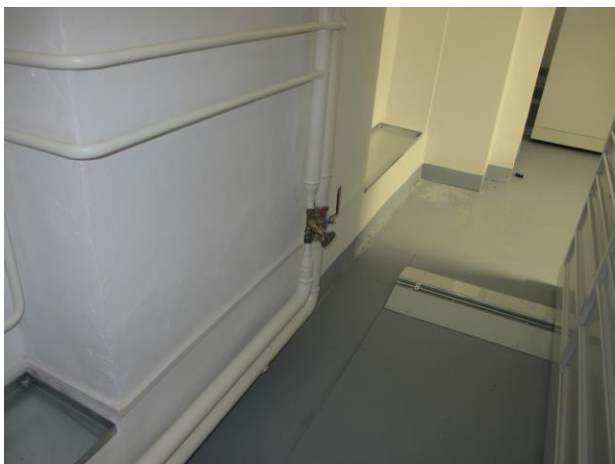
degradace povrchů omítek vč. opadávání maleb
